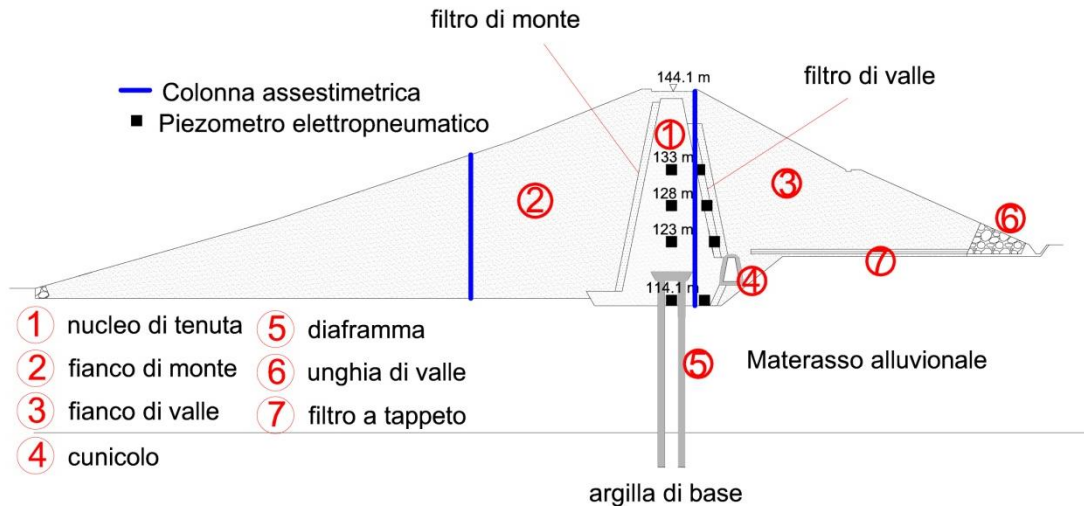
Disposizione degli strumenti di misura nella sezione 2B
